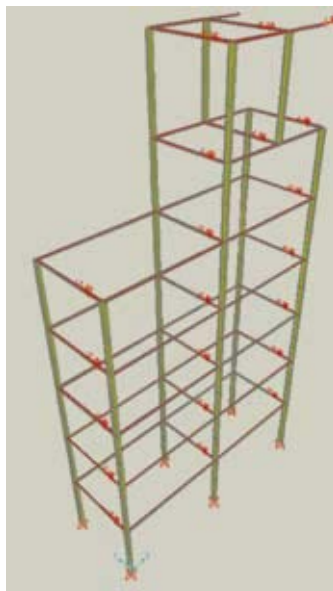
Elementos de vigas em balanço adicionados a estrutura
